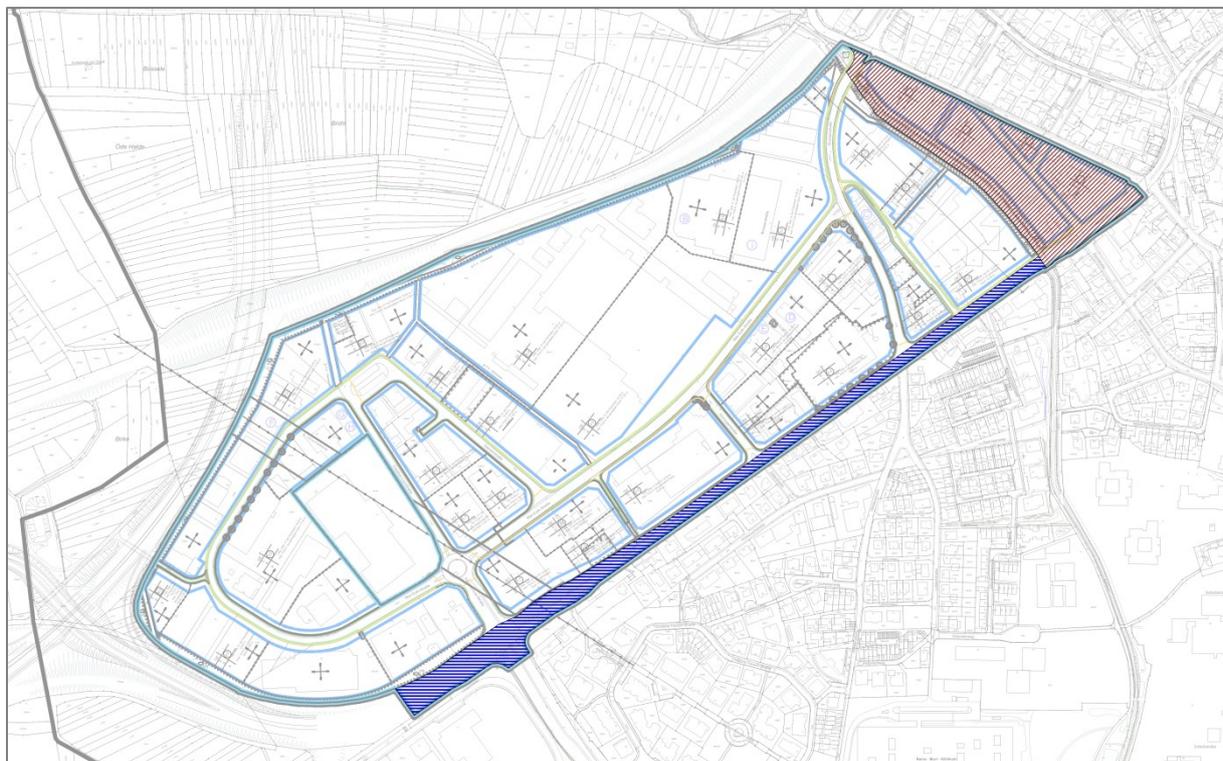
Erweiterter Geltungsbereich B-Plan „Langes Gewand“
